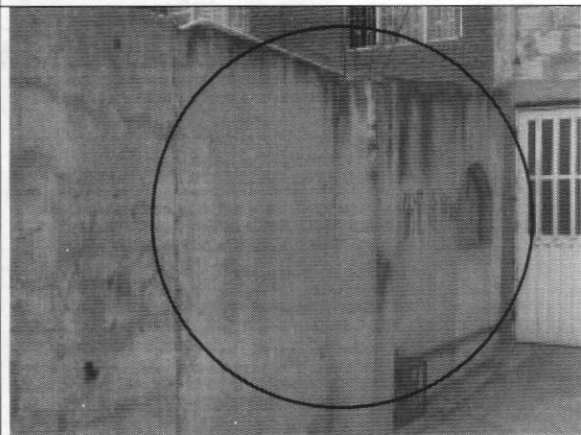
Fisuras en muro costado norte, cerramiento frontal
